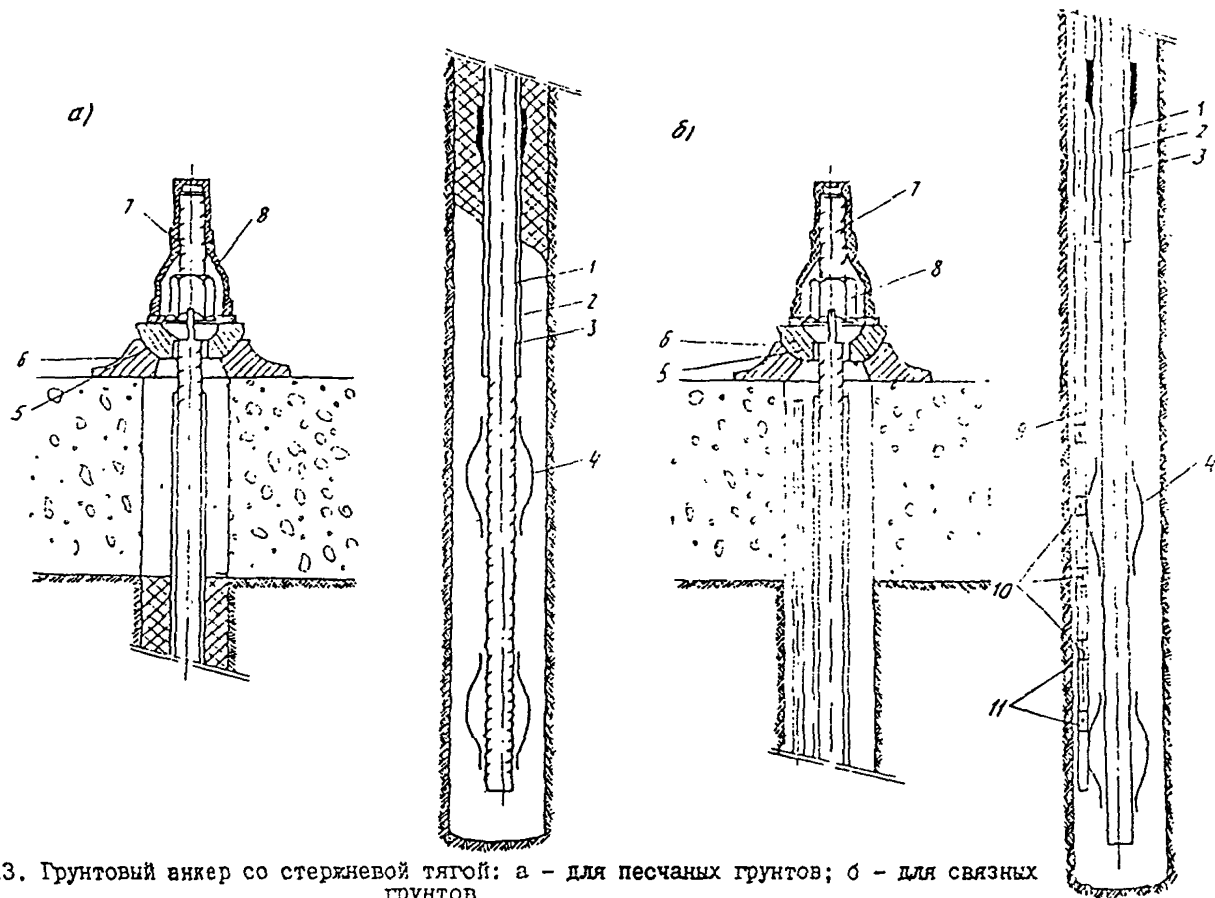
Грунтовый анкер со стержневой тягой: а - для песчаных грунтов; б - для связных грунтов
